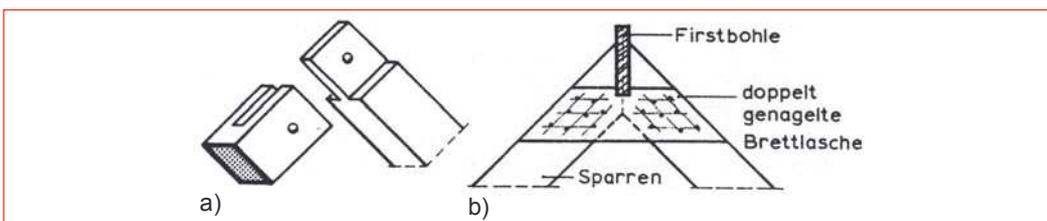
Firstpunktausbildung eines Sparrendaches: a) Scherzapfen mit Holznagel,
